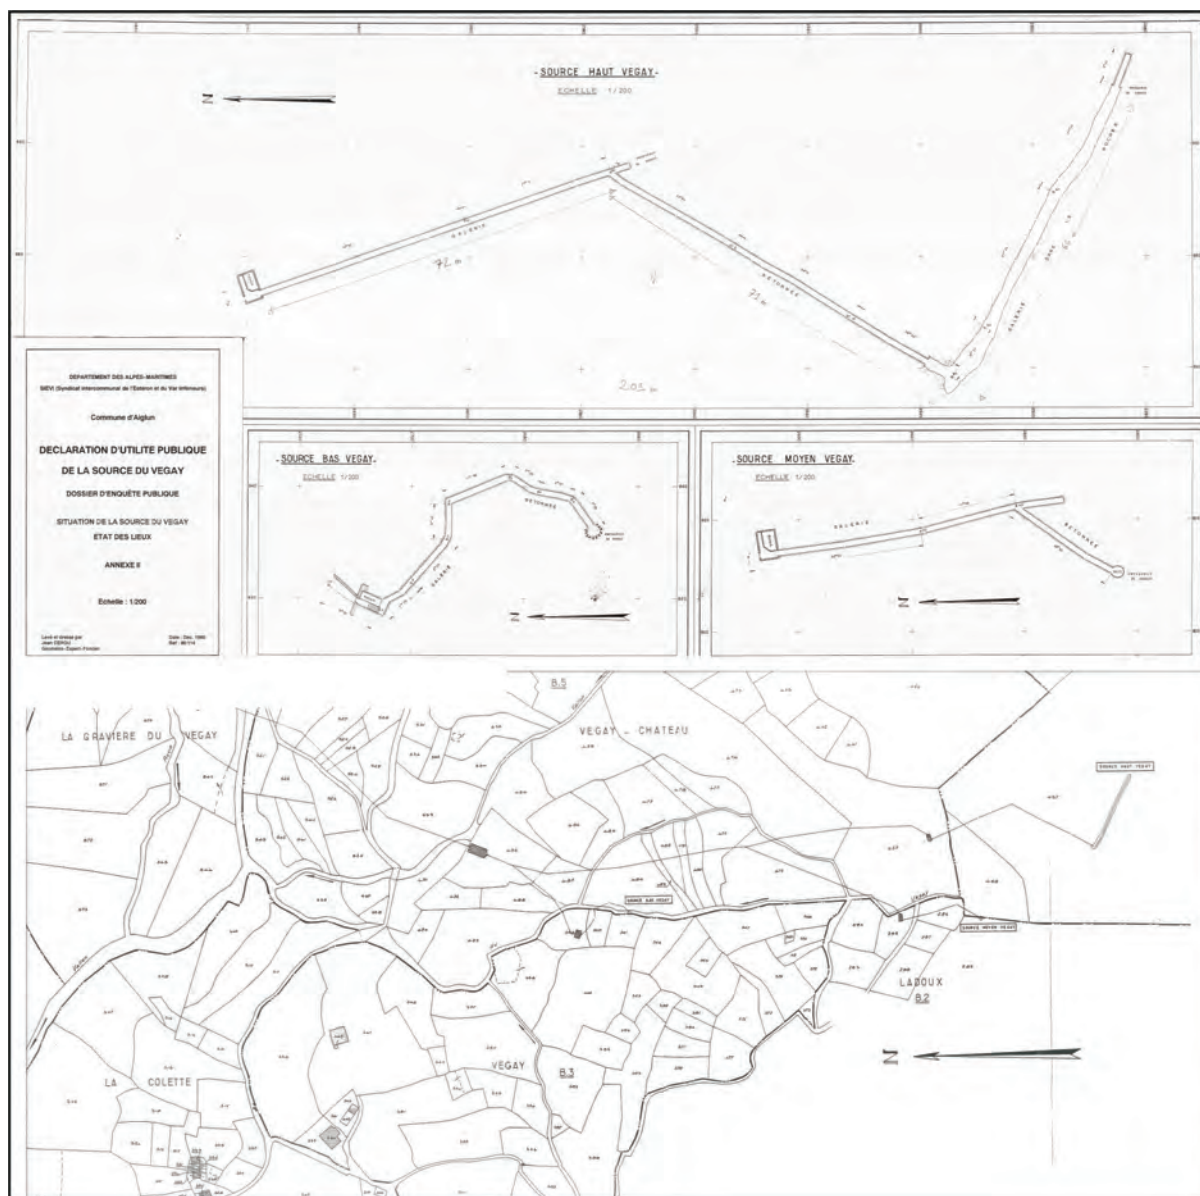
1980, Cérou, Plans des galeries du Végay (incomplet) et extrait de plan parcellaire (plans).
